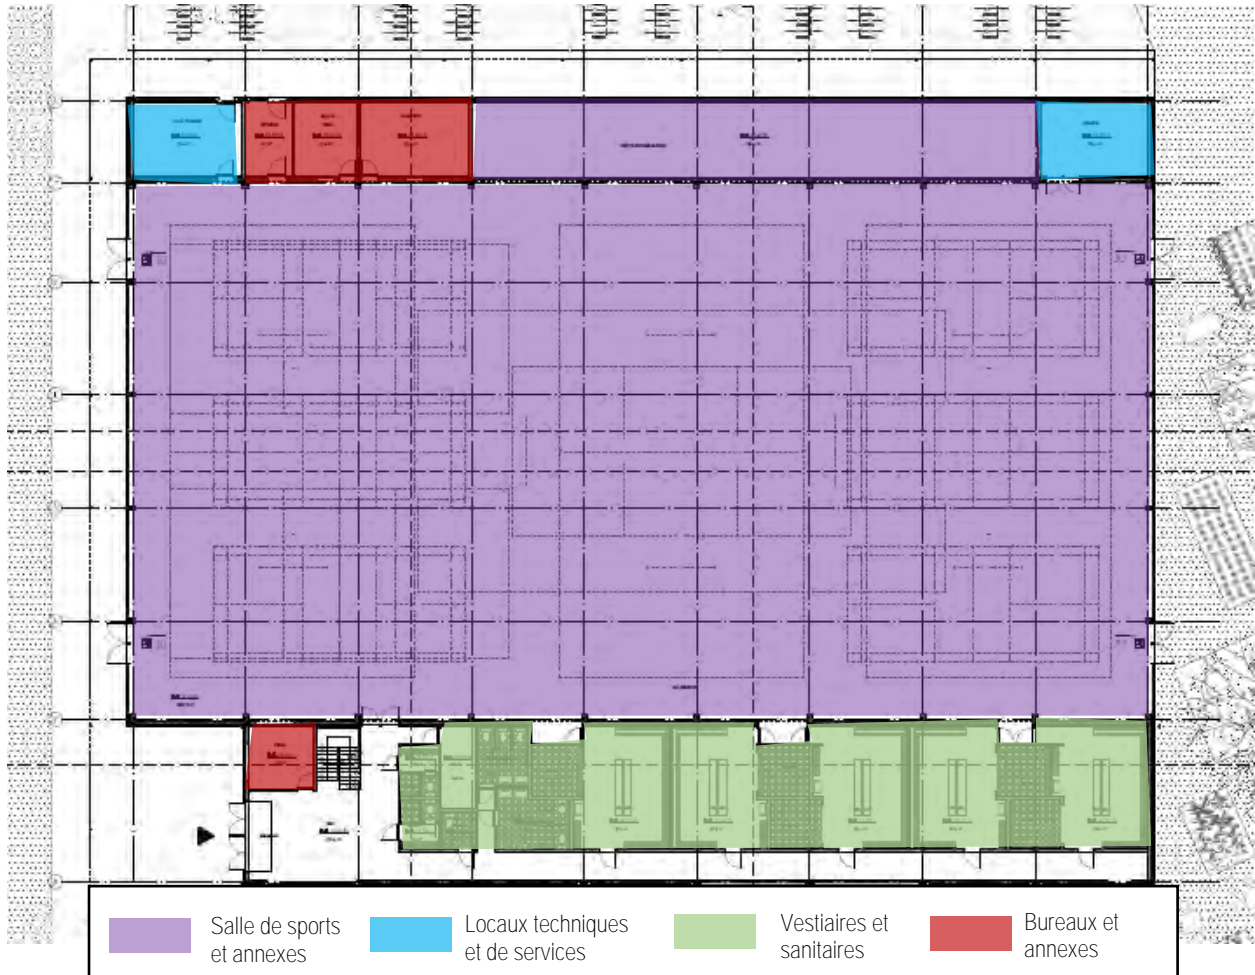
Plan du hall omnisports RDC (ARIES sur fond 51N4E)
